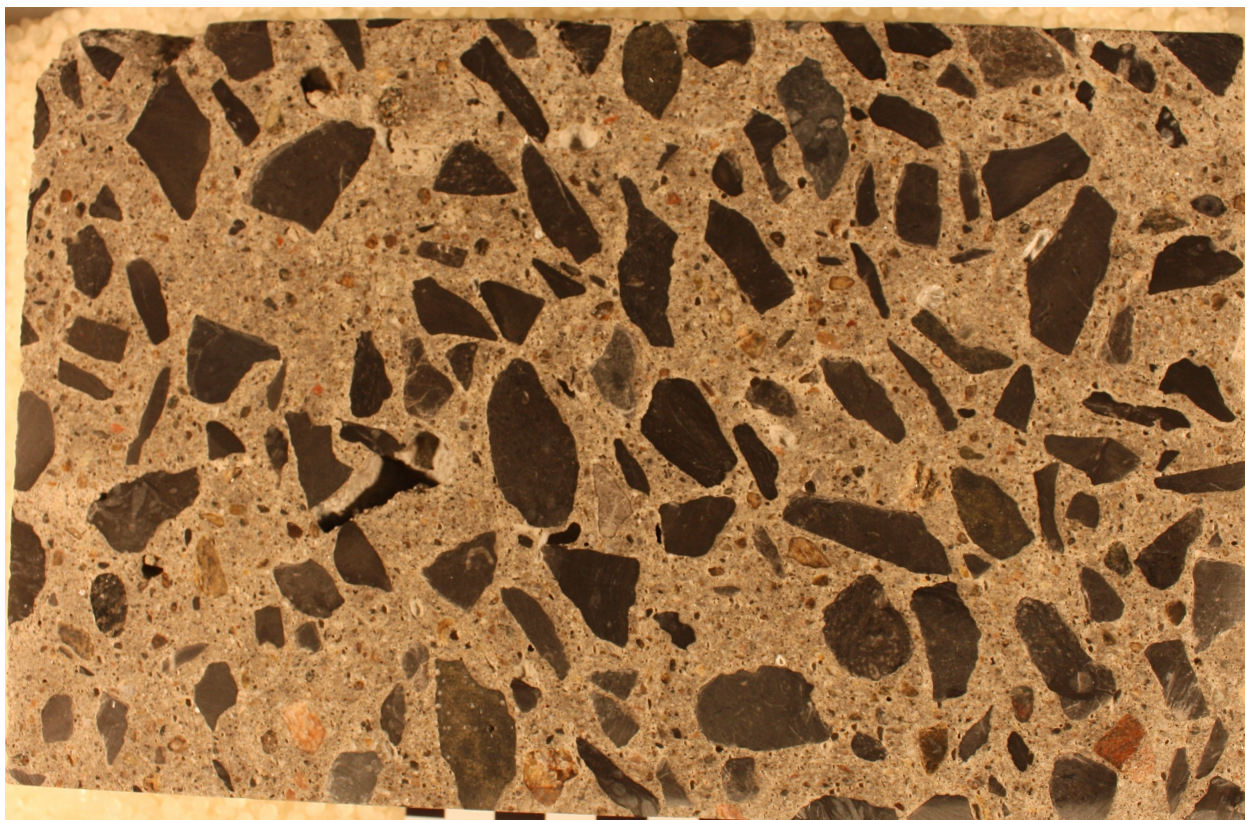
Section polie - Élément D7-38-2-C8-S2-2
